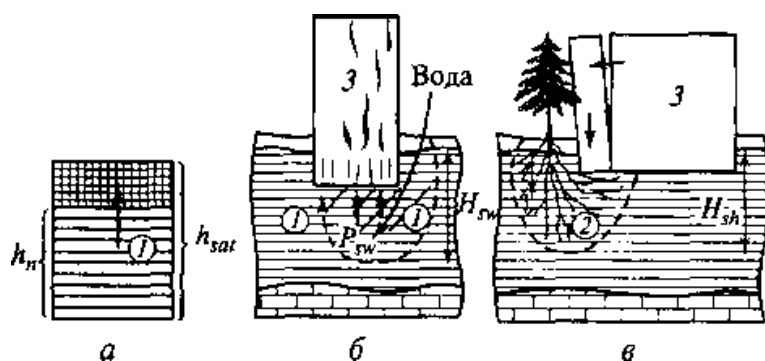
Схема набухання ґрунтів (а), тиск набухання на фундамент (б), деформація будівлі від просадки ґрунту (в): 1 – набухаючі ґрунти; 2 – зона просадки ґрунту; 3 - будівлі
